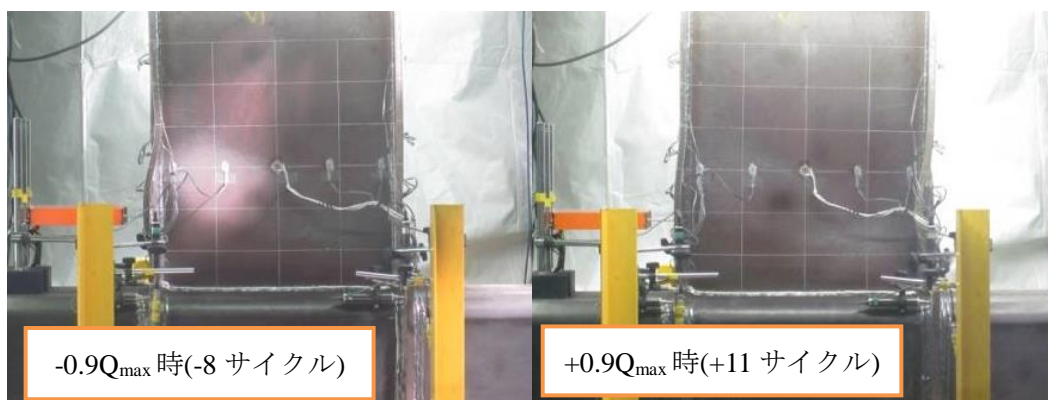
(c) 破壊状況(試験体 AD-3)
